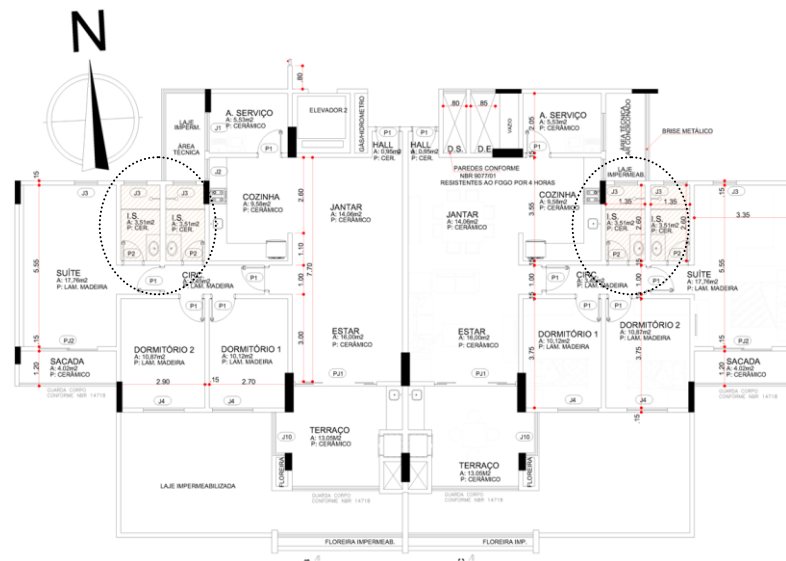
Demonstração Iluminação no Pavimento Tipo.
